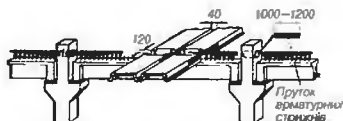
З'єднання збірно-монолітної конструкції каркаса будівлі
